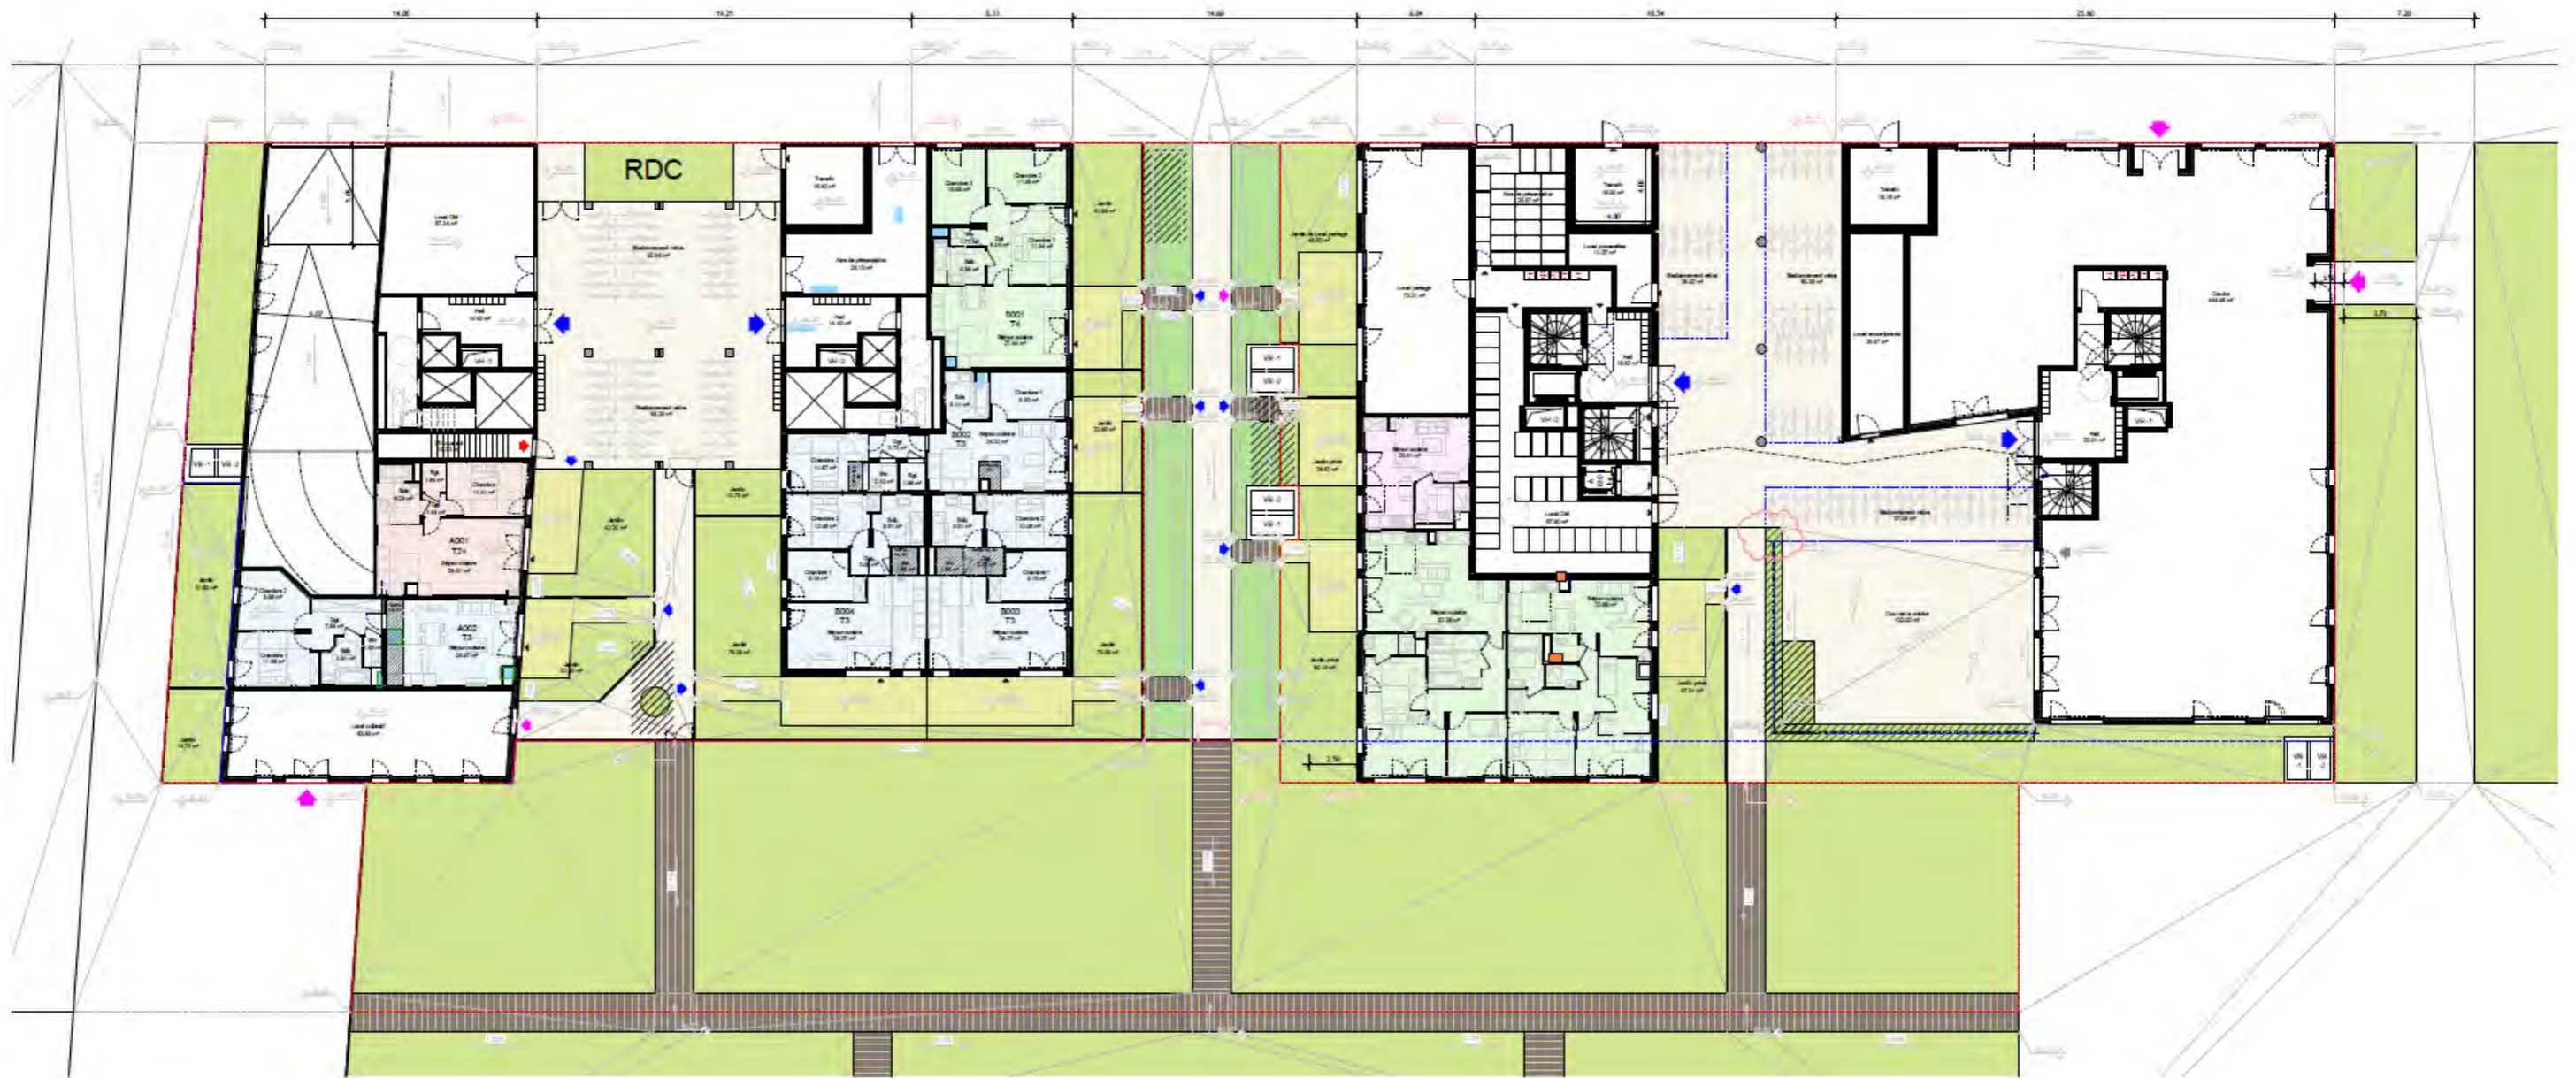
Plan masse du RDC des bâtiments du lot 3.1
